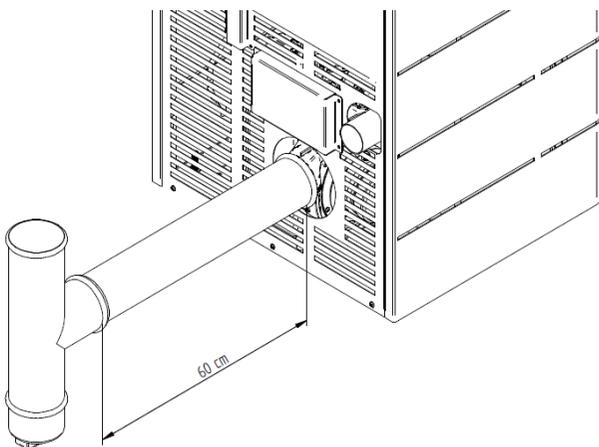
Instalação de um t de inspeção com uma peça de aumento
